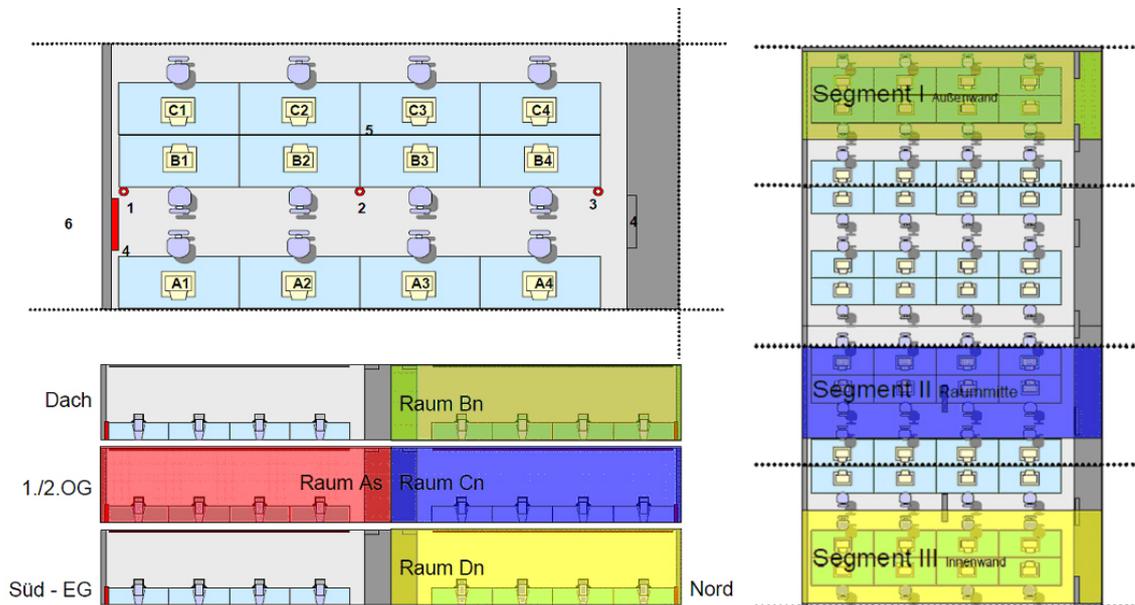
Grundriss eines Messsegmentes (links oben); Gebäudeschnitt (vertikal) mit der Lage der Messräume (links unten); Grundriss eines Messraumes mit Lage der Segmente (rechts)
